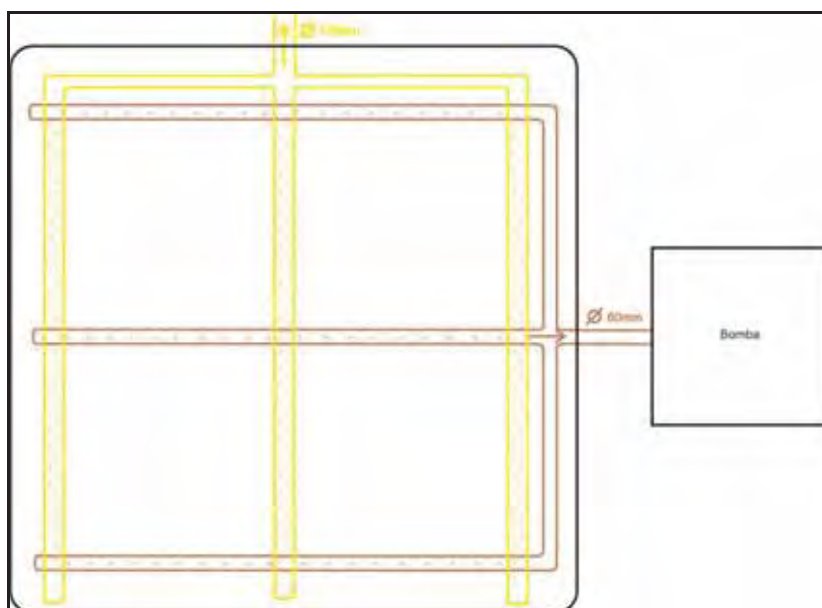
Planta de fundo dos Alagados Construídos de fluxo vertical.
